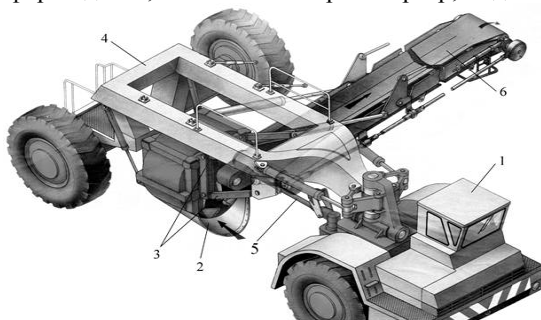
Общий вид самоходного грейдер-элеватора
